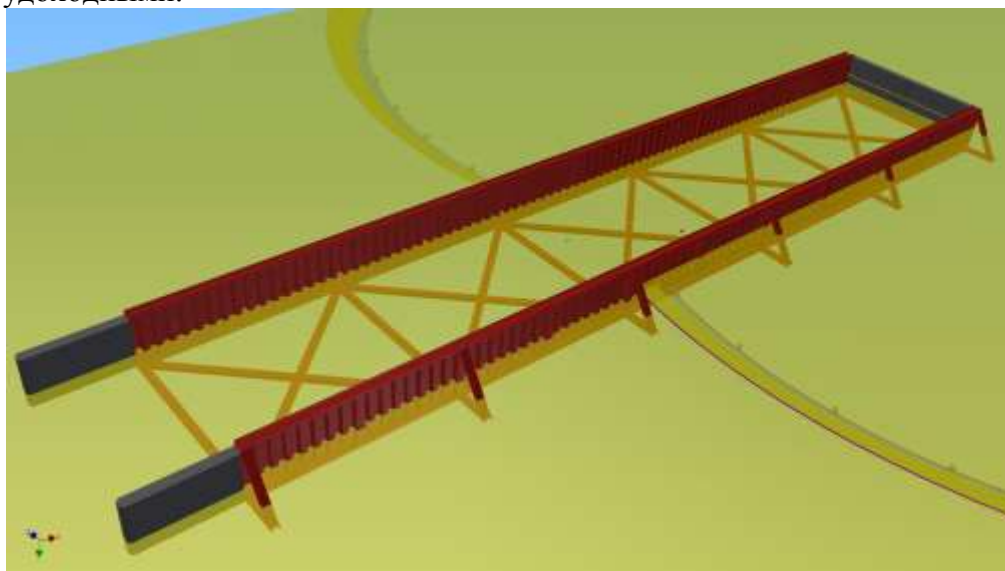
Мобильный шлюз. Вид сбоку-сверху.
